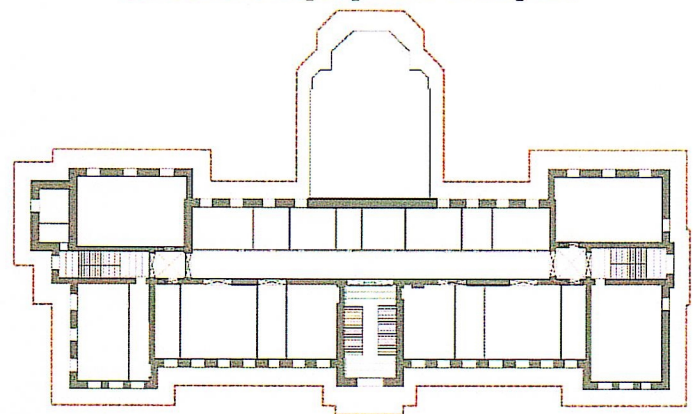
План с обозначением помещения с кирпичной перемычкой арочного проема и сводчатого перекрытия четверика
